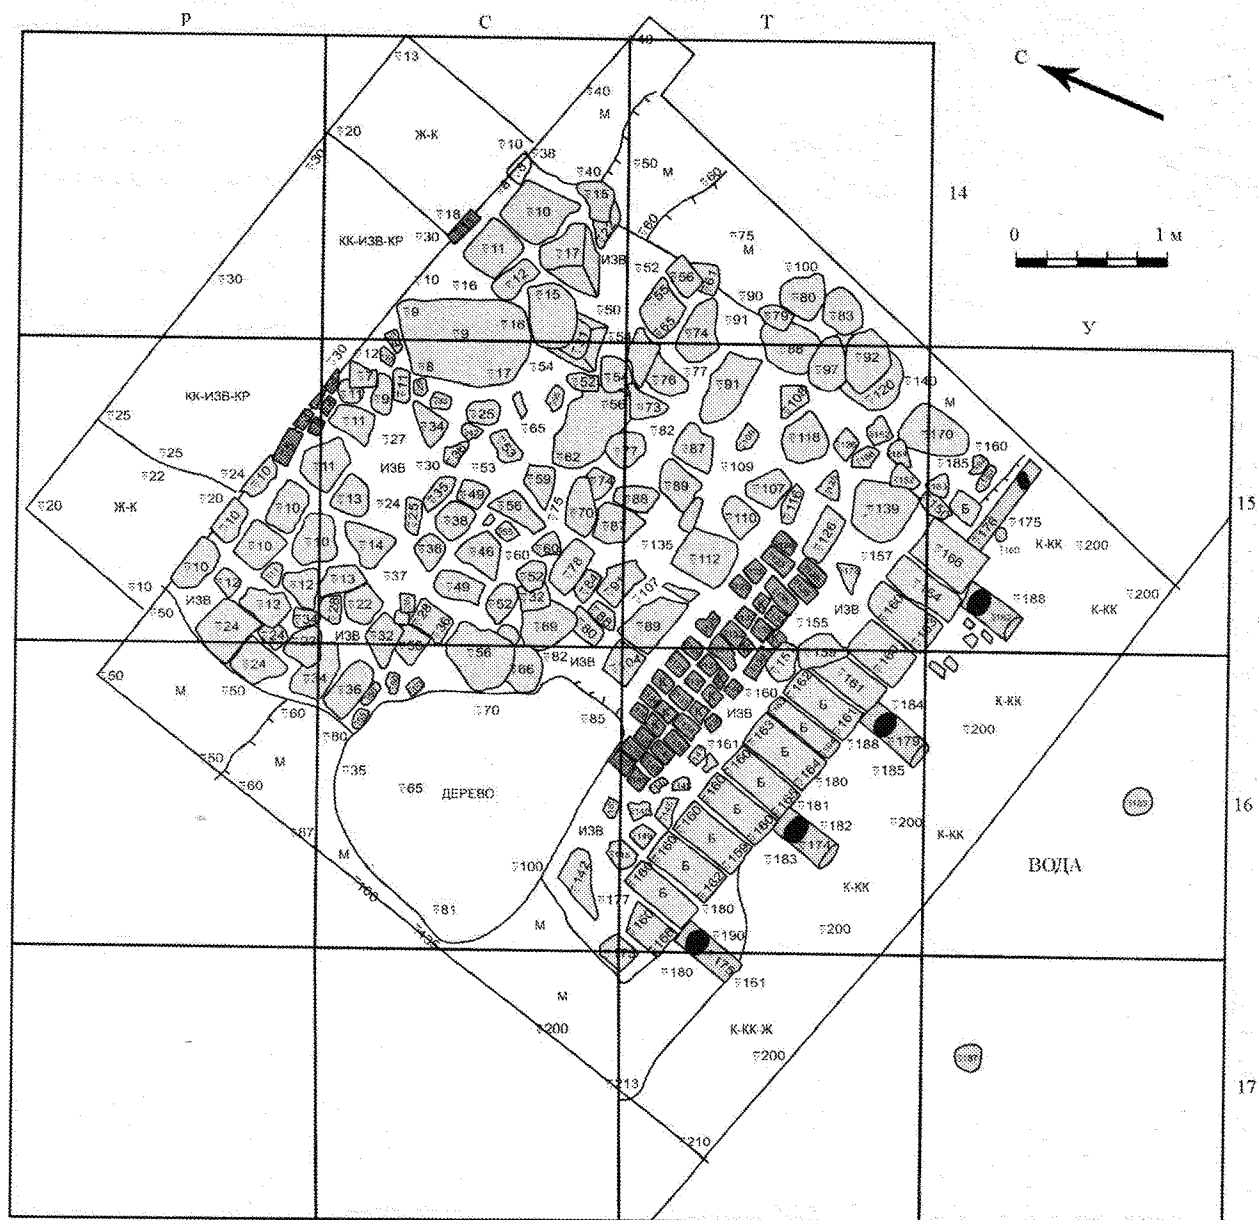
Кузьминки. План фундамента южного моста на остров Щучьего пруда
